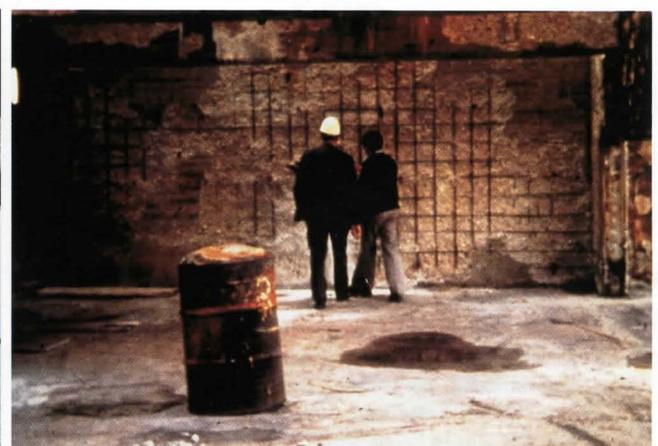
Brandschaden der Schadenklasse III an einer Stahlbetonwand
